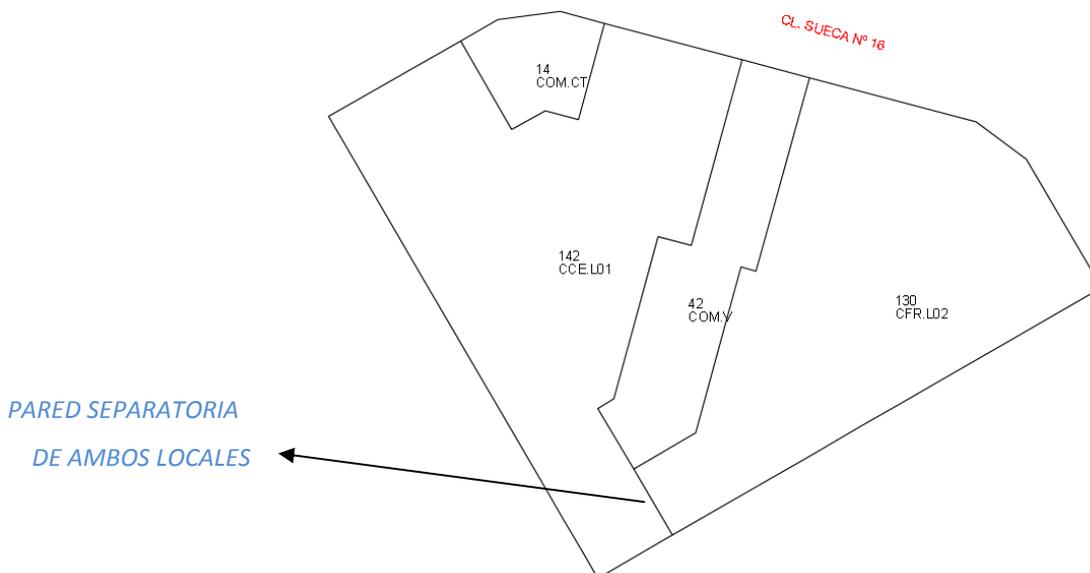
Locales de la planta baja. Plano extraído de la Sede Electrónica del Catastro.
